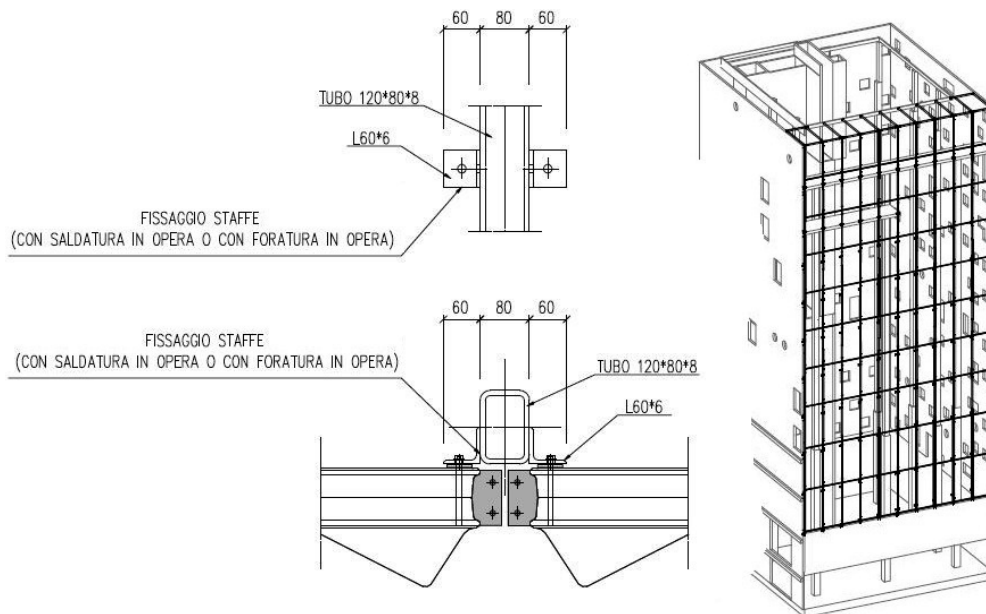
Esempio di configurazione di facciata in vetrocemento a curtain wall con sottostruttura metallica.
